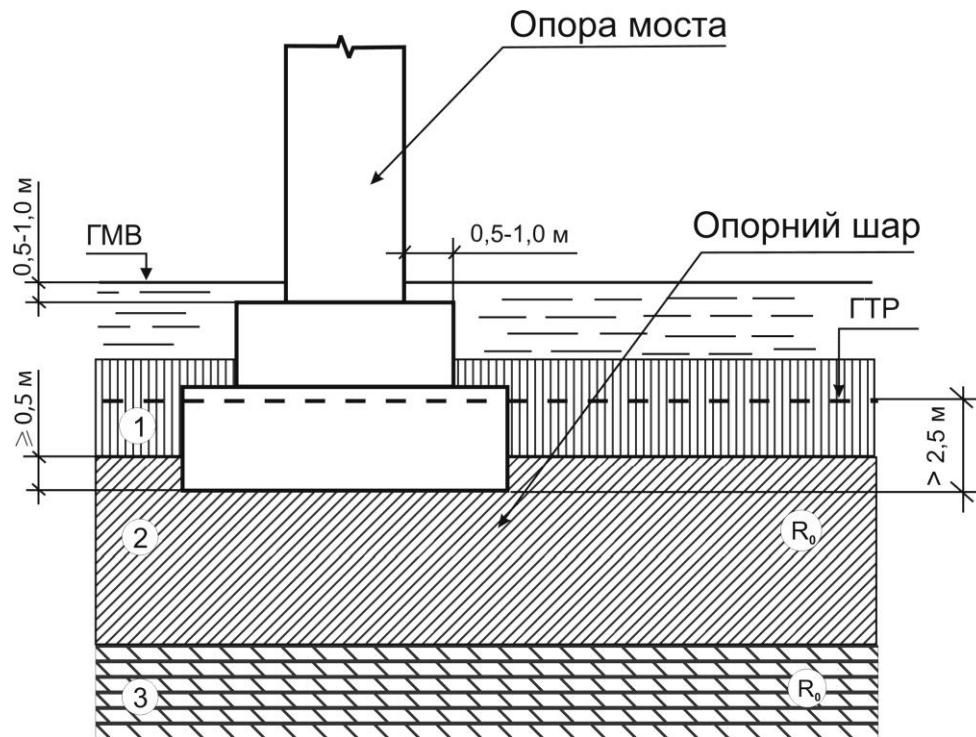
Конструкція фундаменту мілкого закладення на водотоці
